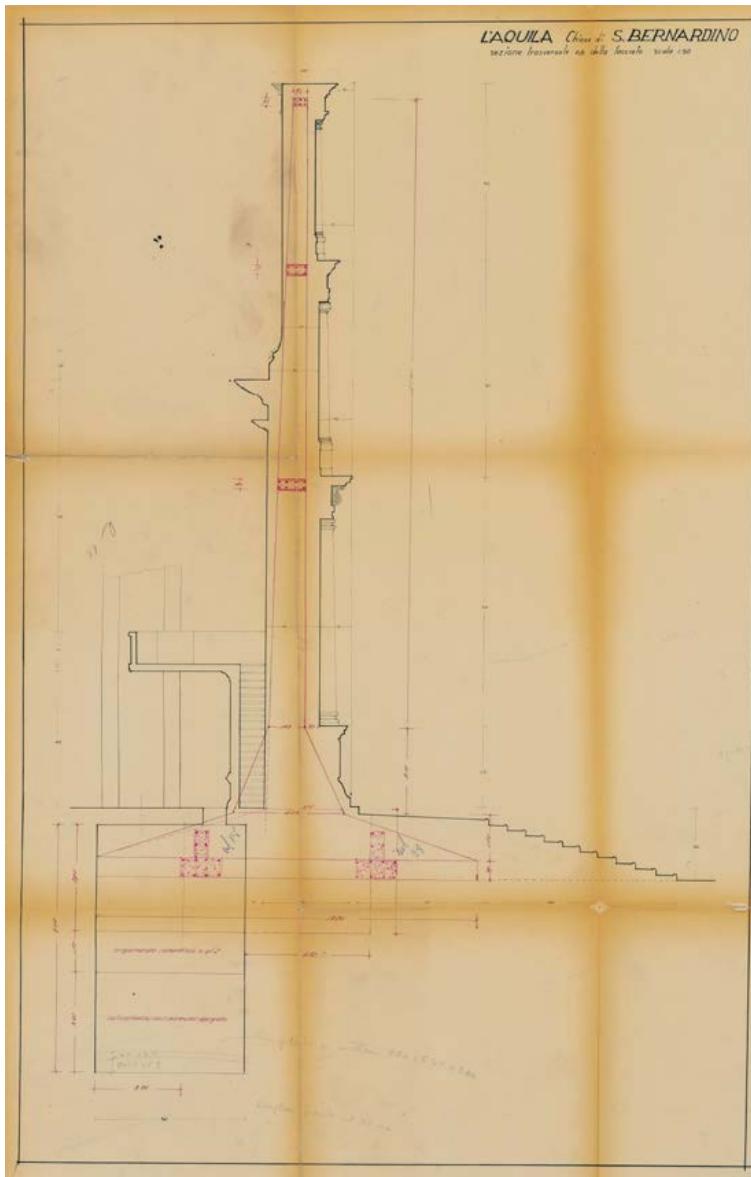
L'Aquila, basilica di San Bernardino, sezione trasversale della facciata con l'indicazione del telaio e delle travi trasversali, qui ridotte a tre rispetto al disegno precedente (manca quella nella parte inferiore). La sagoma della fondazione appare irrealizzabile. ASAQ, Genio Civile, busta 19, s.d. Uso immagine su autorizzazione dell'Archivio di Stato dell'Aquila (ASAQ).
